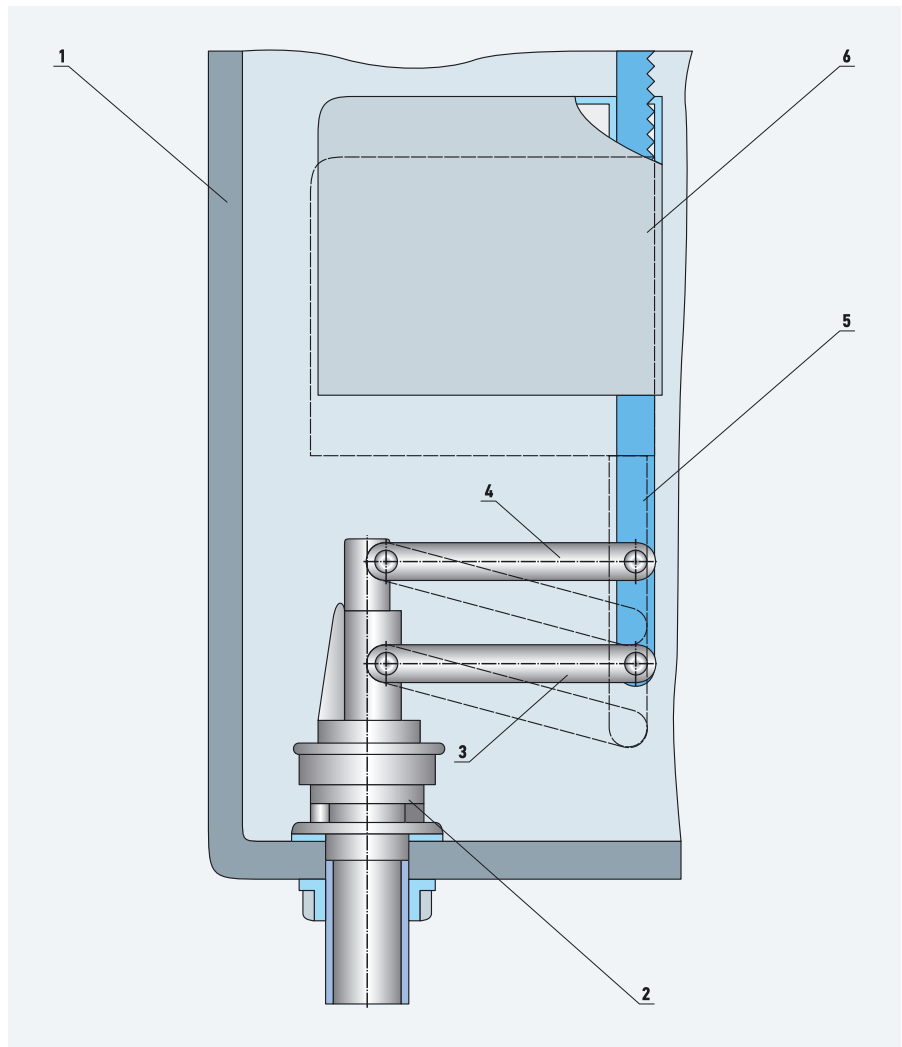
Схема наполнительной арматуры прямого действия нижней подводки с параллелограммным направляющим механизмом (1 — стенки смывного бачка; 2 — корпус арматуры; 3 — активный рычаг; 4 — пассивный рычаг; 5 — штанга; 6 — поплавок)
